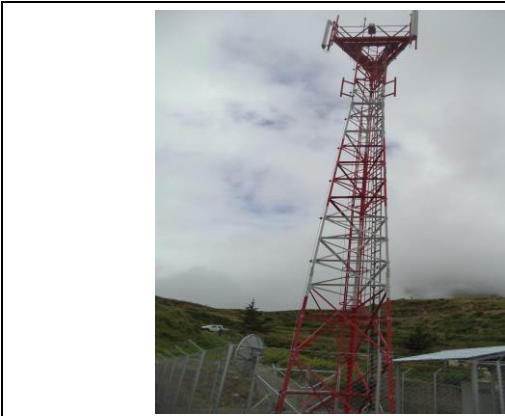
VISTA DE LA ESTRUCTURA, MONOPOLOLO, ETC
